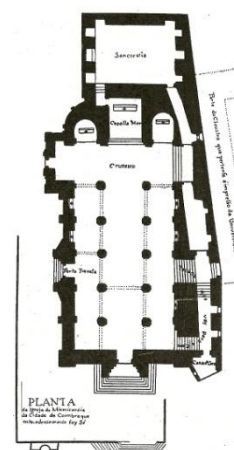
Planta levantada posteriormente em 1773. Com alterações do projecto original. Depositada no Museu Machado de Castro.
